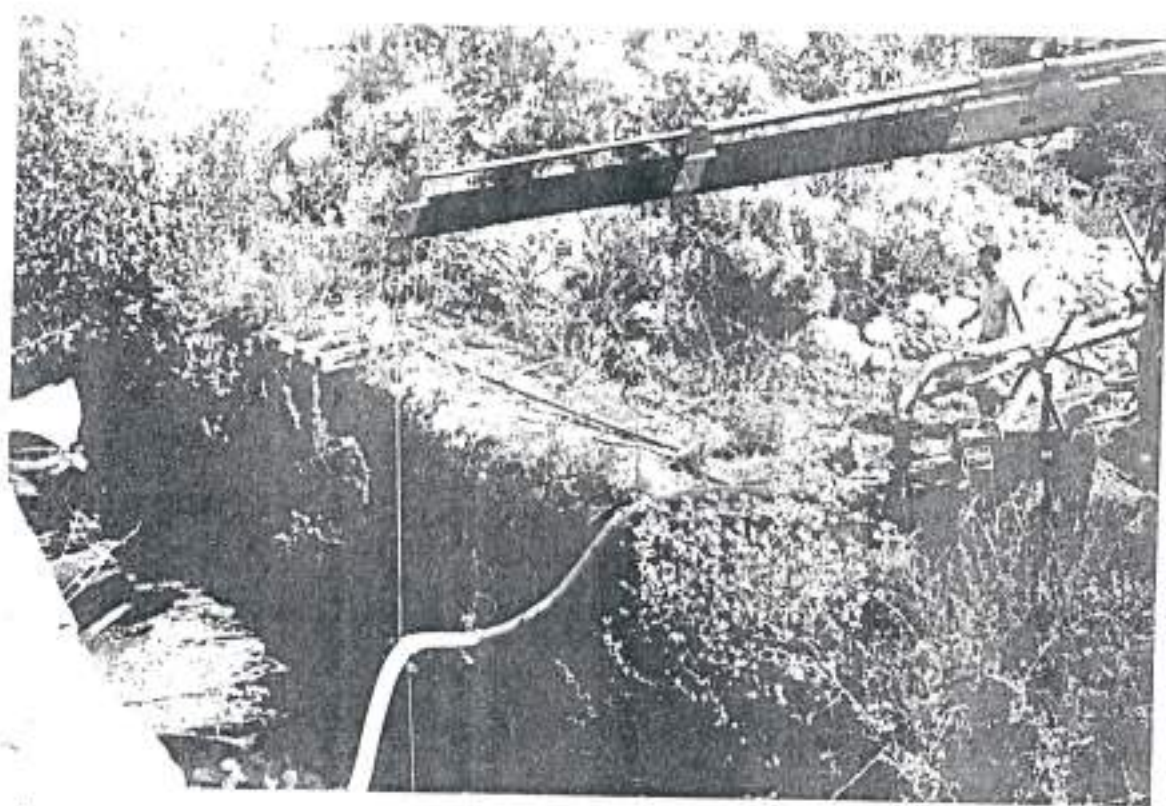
Sorgente Candelaro - Impianto cantiere prova di portata del 25.3.1993
